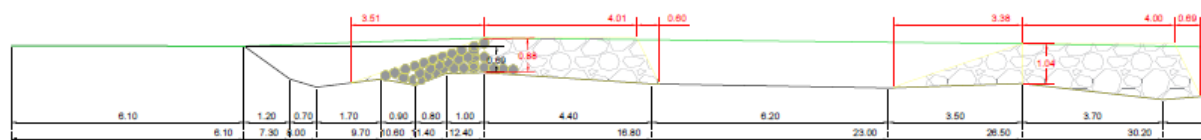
Exemple de plan à destination de la maîtrise d'ouvrage (Auteur : Illona Doyon)
